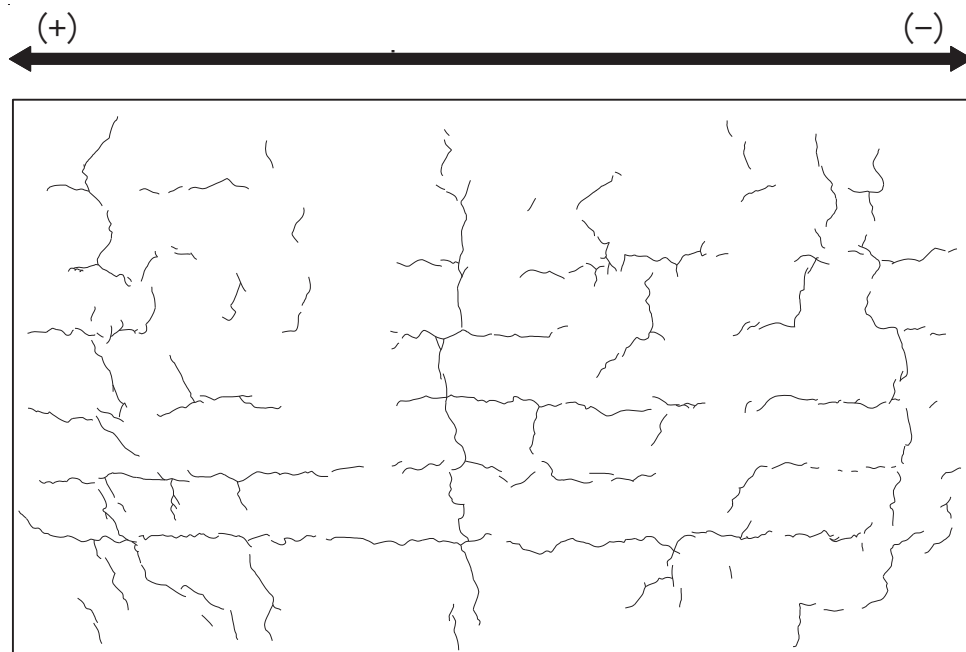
(2) 乾燥試験体 [2] 実験前ひび割れ状況
